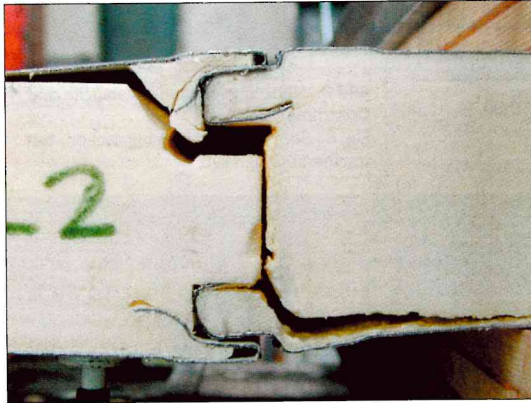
Versagensform einer Längsfuge am rechten Auflager
